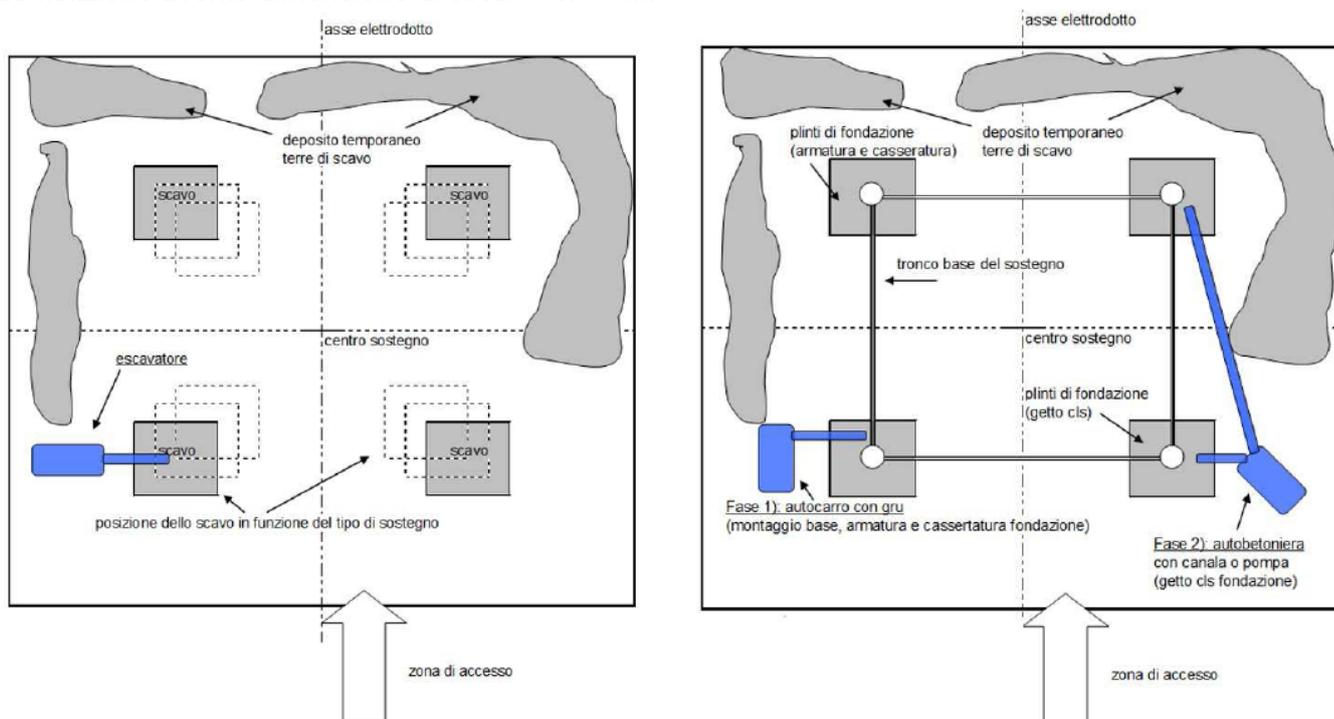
Tipologico planimetria dell'area di micro-cantiere per il sostegno (scavo di fondazione - getto e basi)
